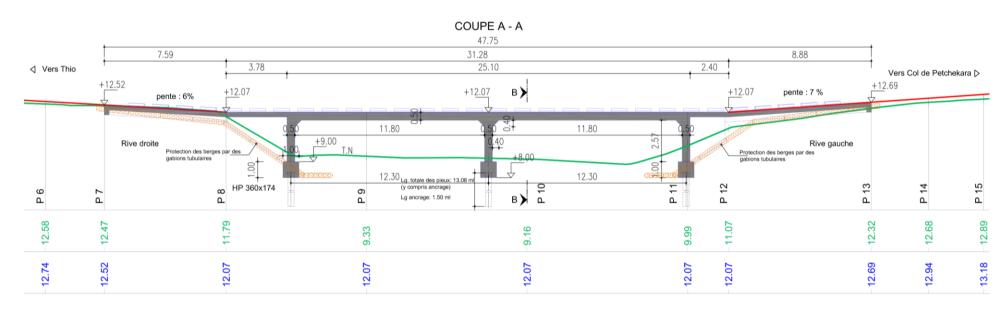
profil en long de l'ouvrage type PIPO monovoie (source: DEPS, 2018).
